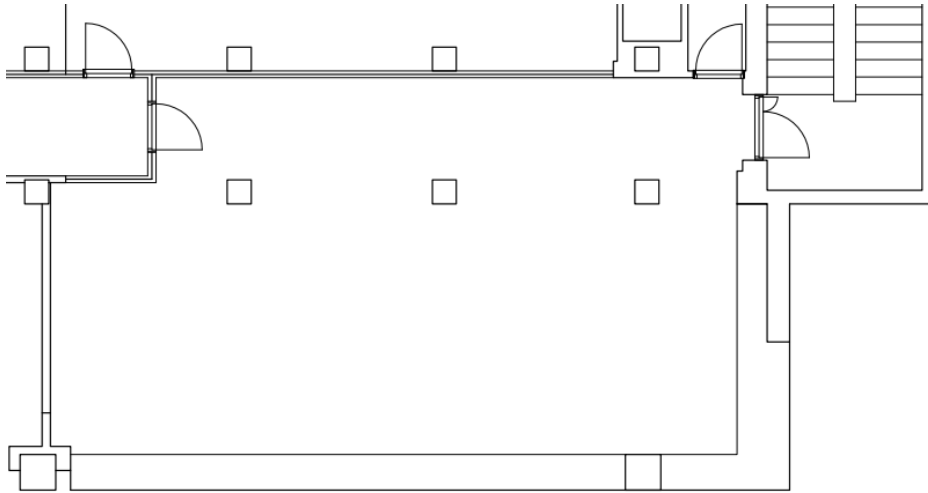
Planimetria dell'aula Training Room 1 di Fondazione Agnelli
